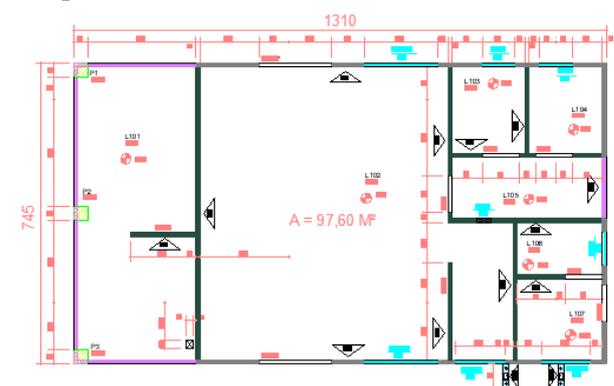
Trecho da planta baixa da 1ª fiada da alvenaria de blocos de concreto.
